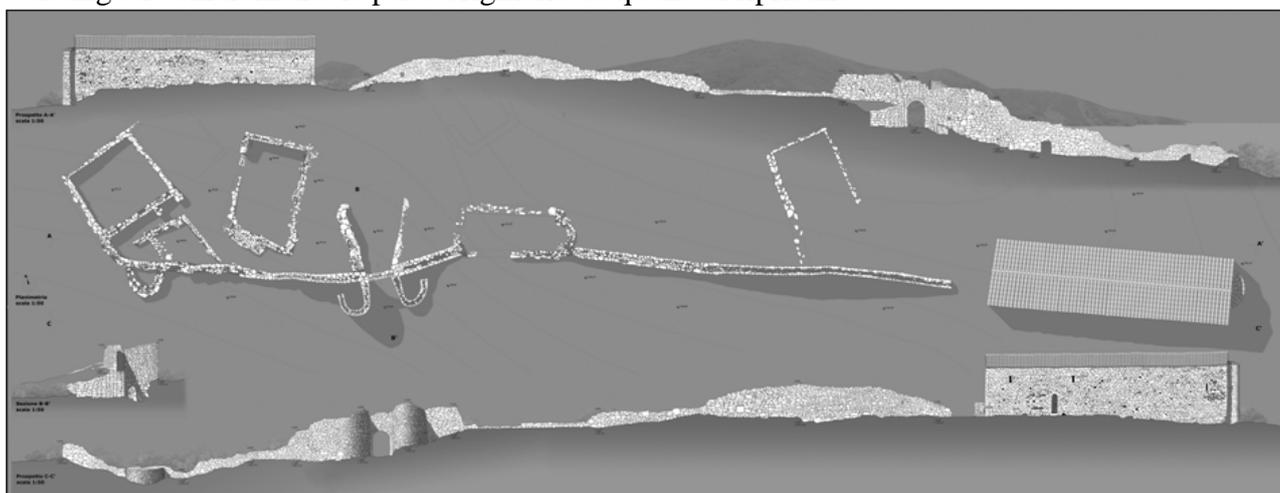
Pianta e prospetto della seconda cinta di mura e delle strutture insediative e di culto.
